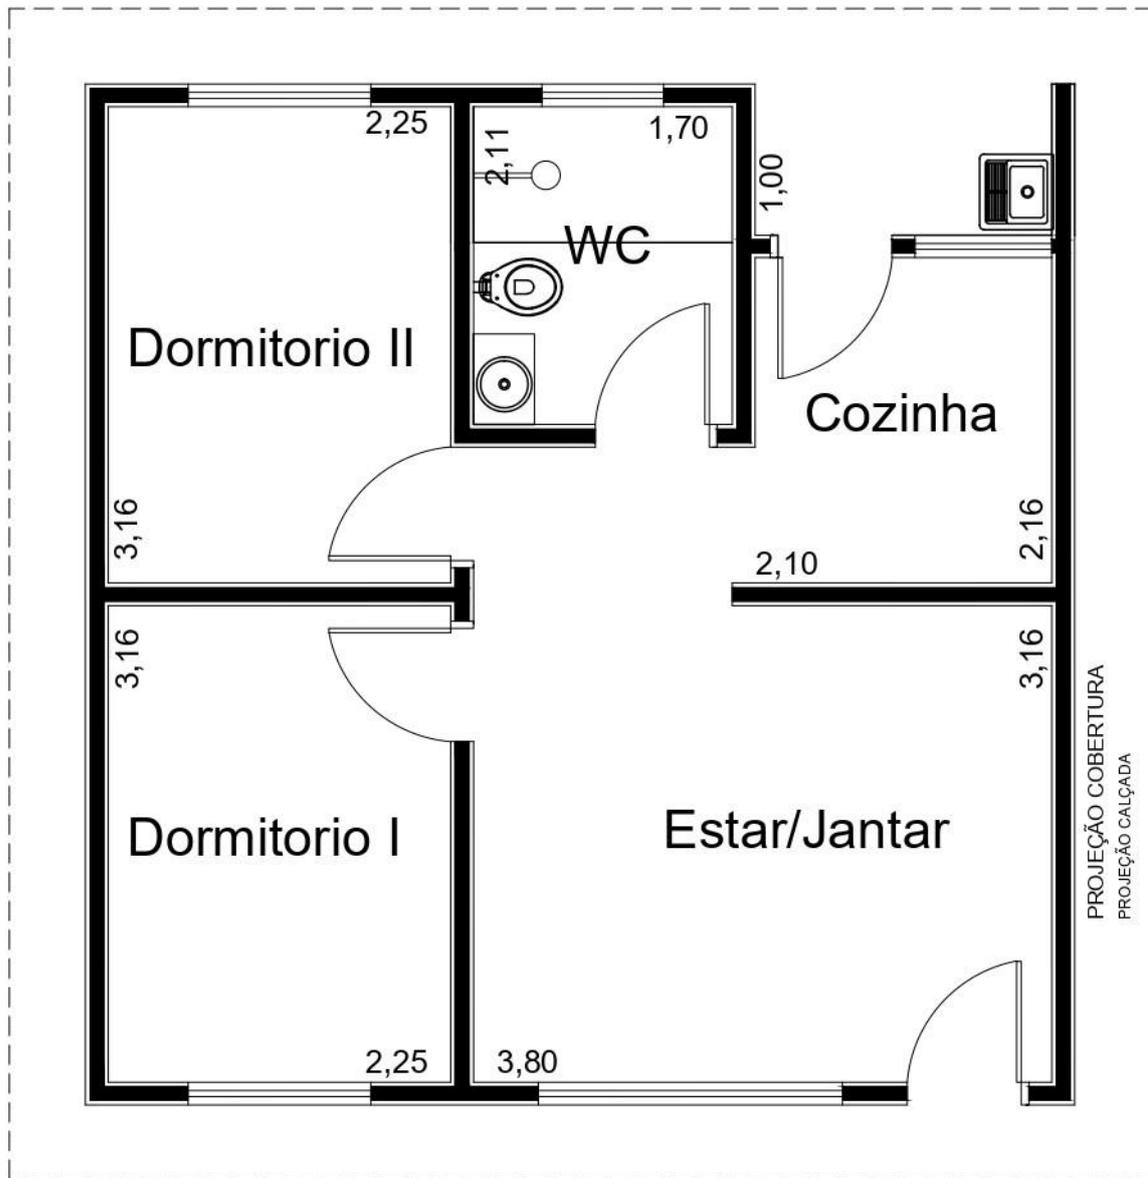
Planta baixa 1 Conjunto Habitacional Joao Domingos Netto – CHJDN
